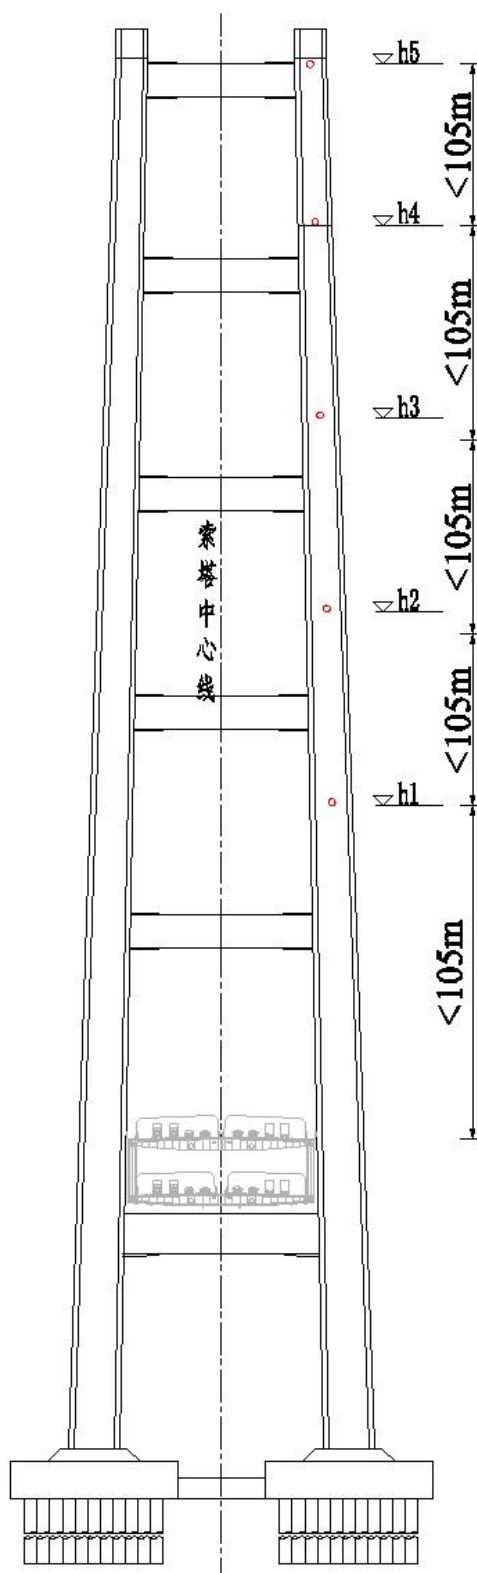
桥梁立柱障碍灯布置平面图
